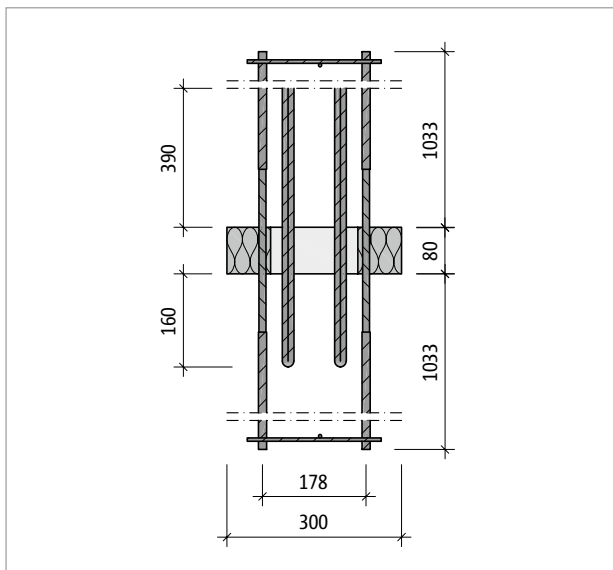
Schöck Sconnex® type W-N1T1-V1H1-LW : coupe B-B du produit
